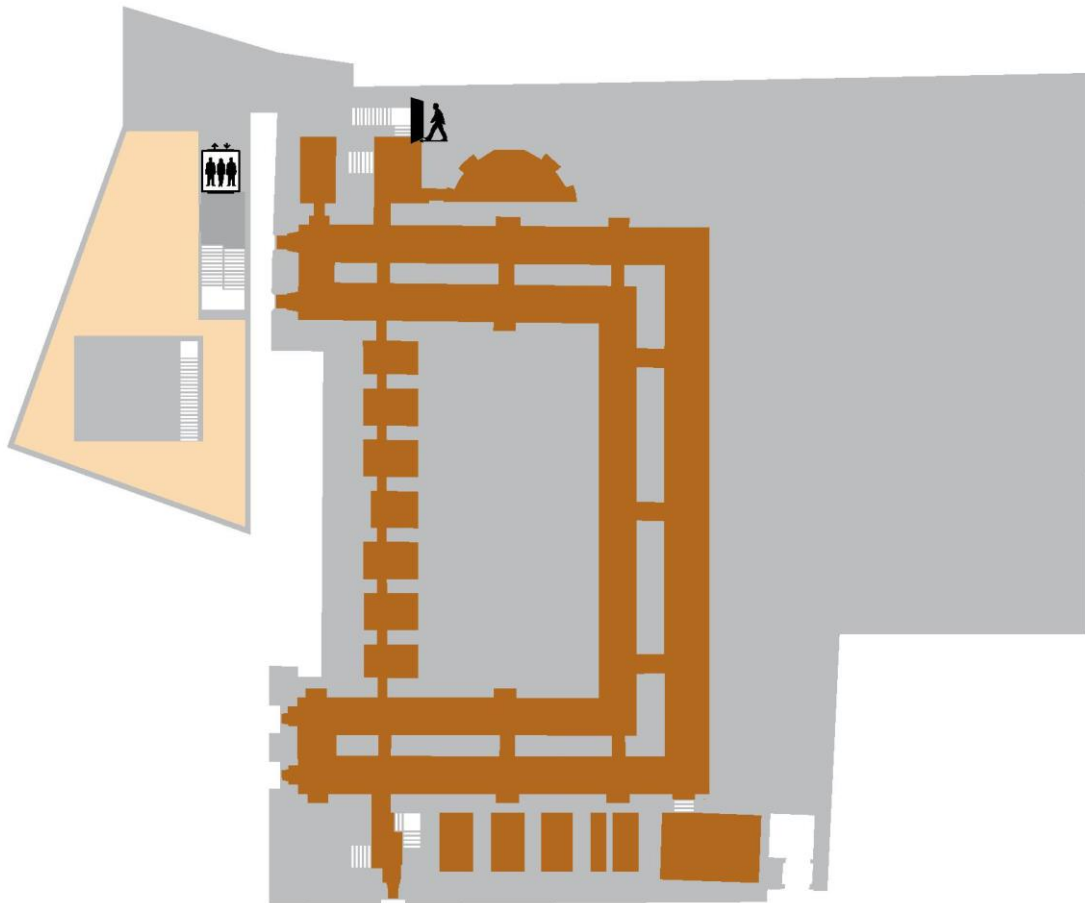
Planta das áreas expositivas do piso -1 (©FBA)
